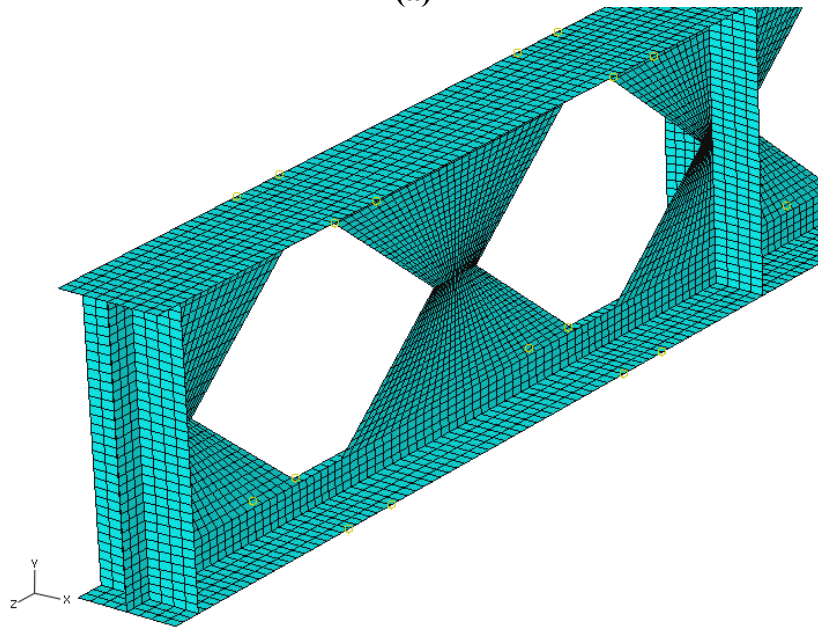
Geometria das vigas G, H e I ensaiadas por Toprac e Cooke (1959).
